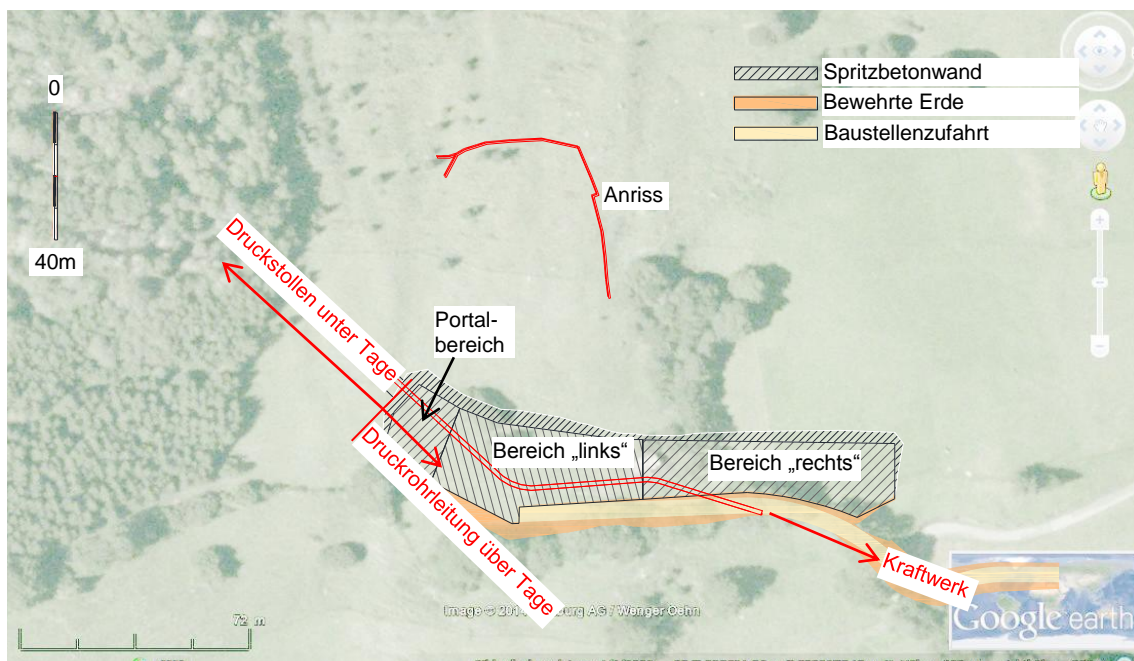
Aushubbereiche und Baumaßnahmen im Lageplan [3], [15]
